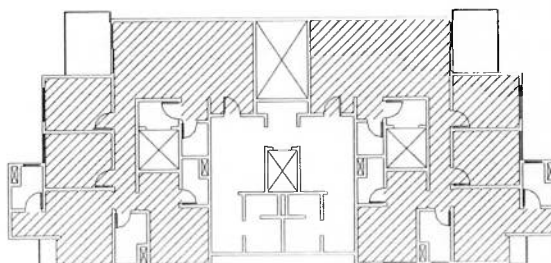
Planta do pavimento-tipo indicando, com hachuras, os ambientes nos quais o revestimento interno em gesso foi executado (Obra SP 33).
